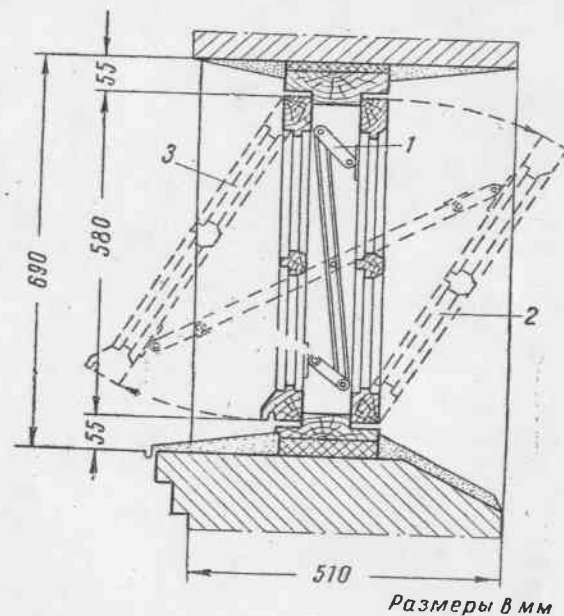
Открывание переплетов с помощью фрамужного прибора: 1—фрамужный прибор; 2—внутренний переплет; 3—наружный переплет.
